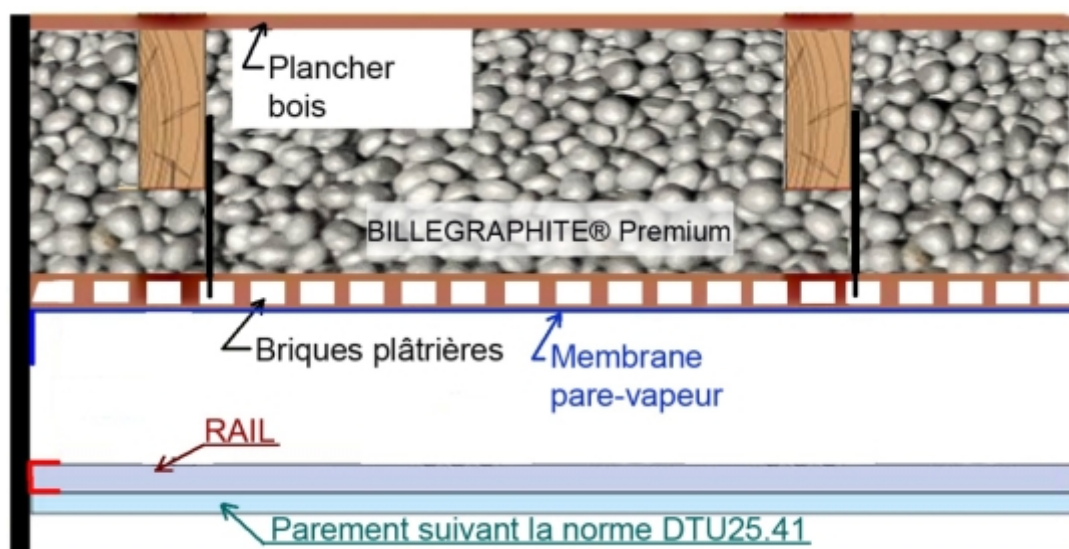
Pose d'un plenum autoportant après la pose du pare-vapeur après insufflation
